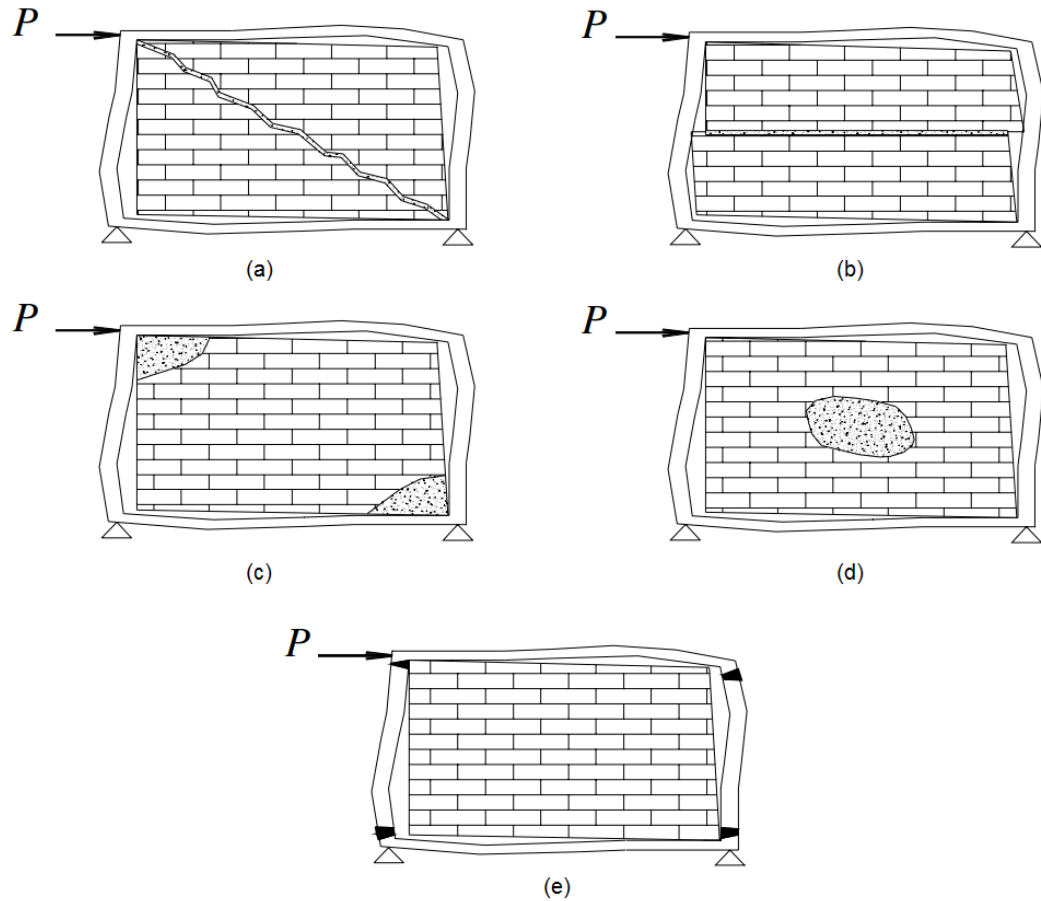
Les modes de rupture en-plan des murs de remplissage (El-Dakhkhni et al. (2004)) : (a) Fissuration diagonale (b) cisaillement horizontal (c) écrasement des coins (d) écrasement diagonale (e) fissuration dans le portique
